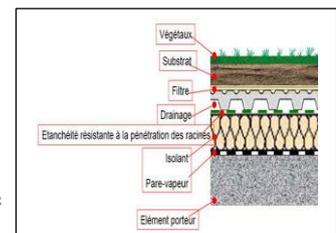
coupe sur a toiture vegetale – source : <https://www.derbigum.fr/etancheite/toitures-vegetalisees/>
